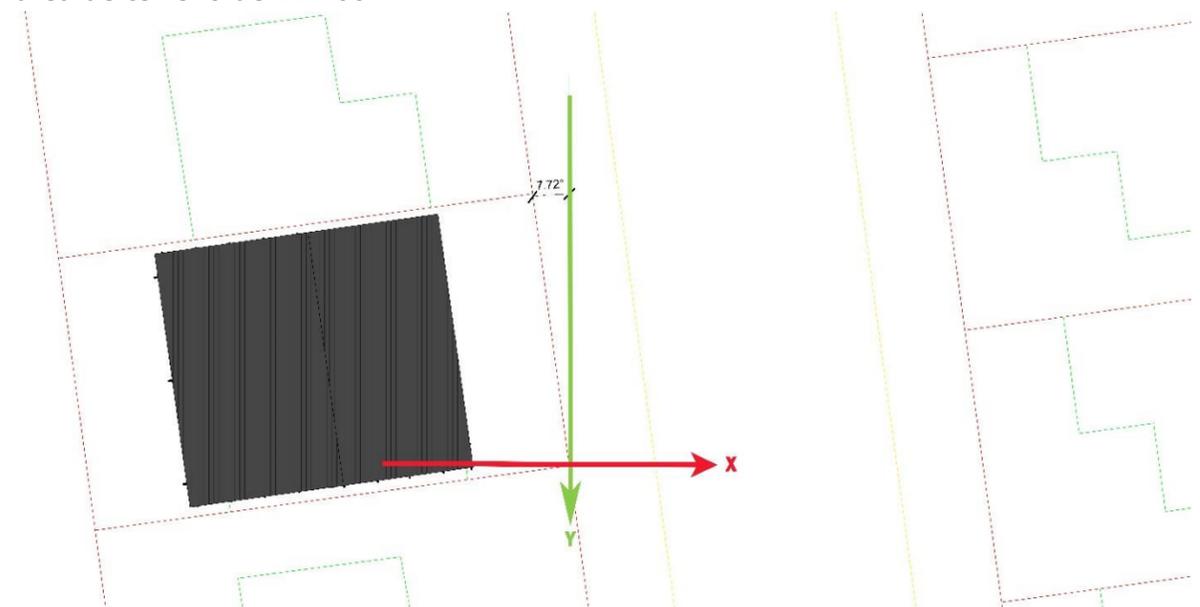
Plano de distribución de techos Vivienda Modelo C-12, ubicado en conjunto con plano cartesiano.
